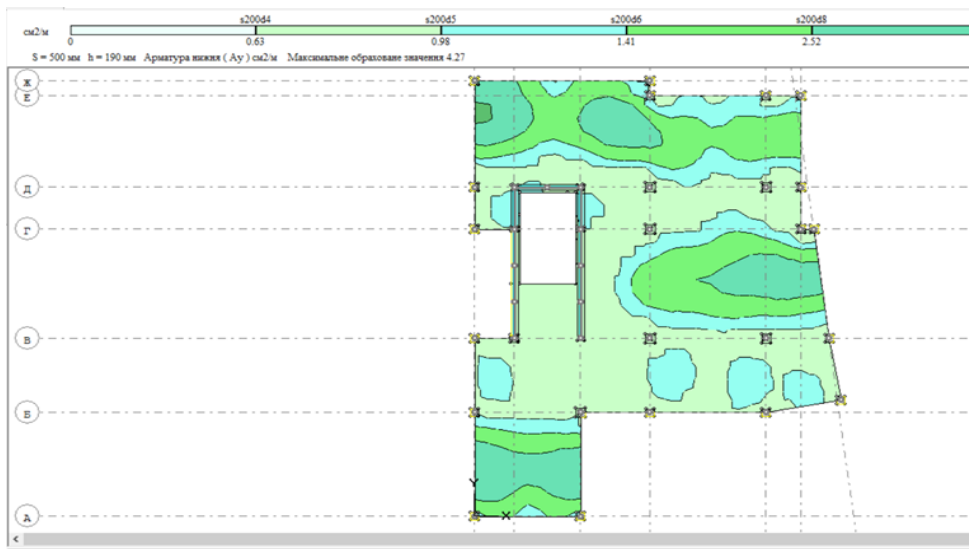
Арамування плити перекриття нижнє по осі Х
